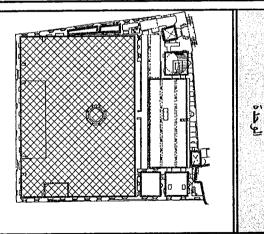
مسقط أفقي مدرسة المؤيد شيخ [188:161]
